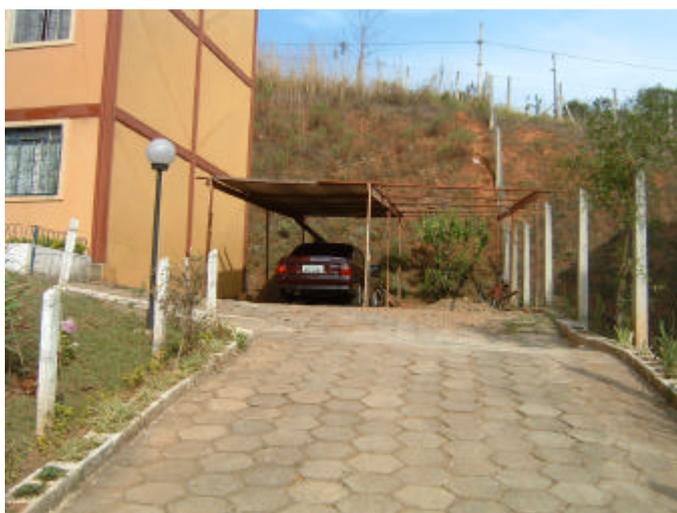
Vista da rampa para a garagem e para pedestres.
